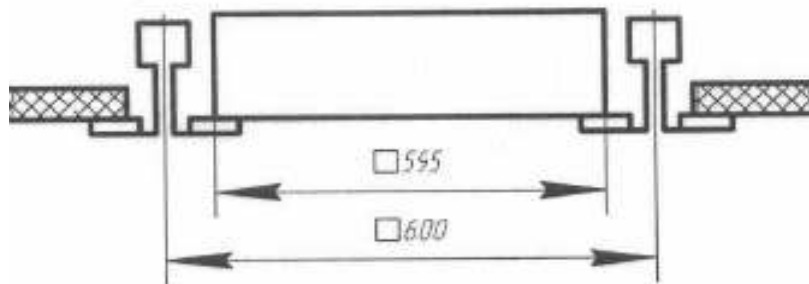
Схема установки светильника в подвесной потолок "Армстронг"
